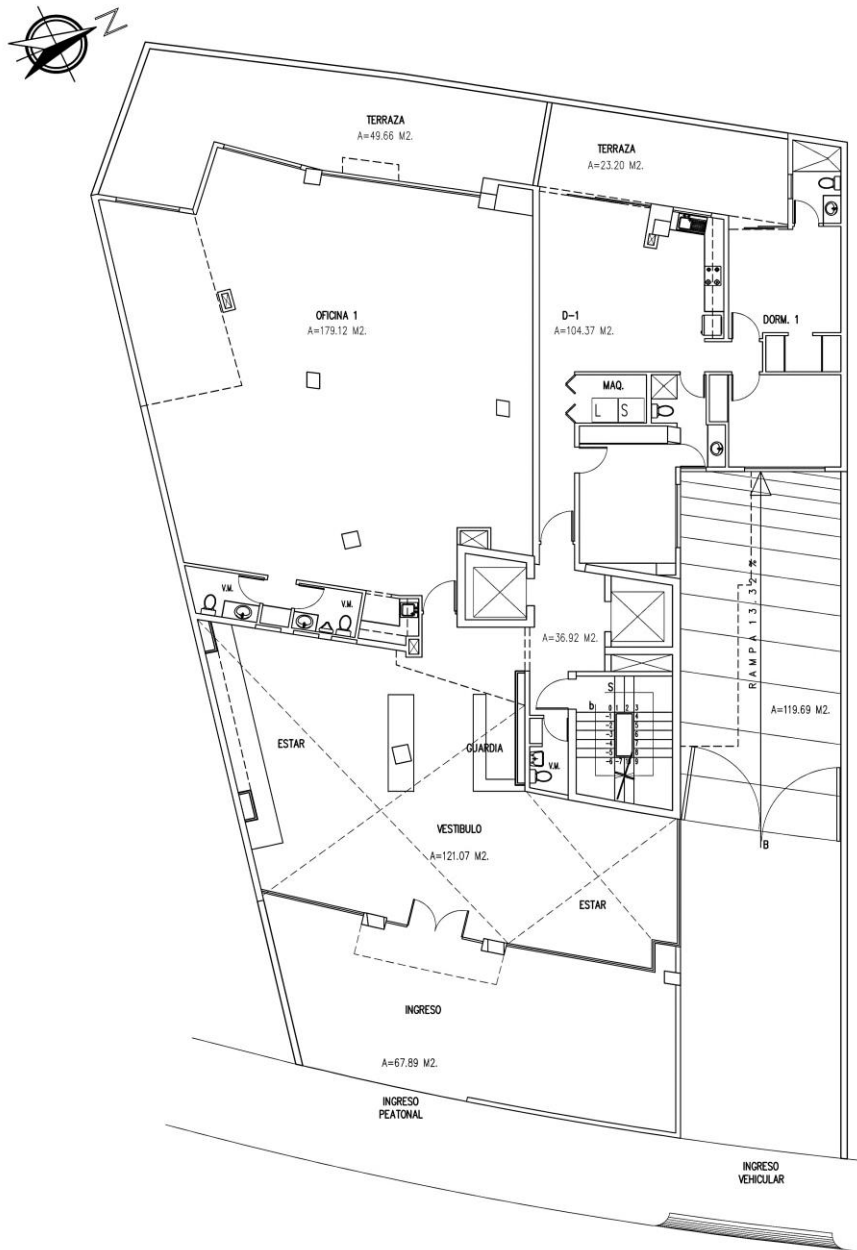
Planos Arquitectónicos Edificio Bohème – Planta Baja
